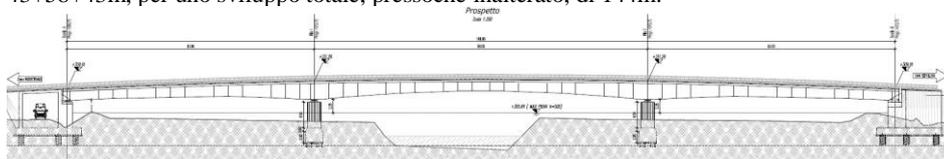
Nuovo ponte sul Fiume Tevere - Prospetto
